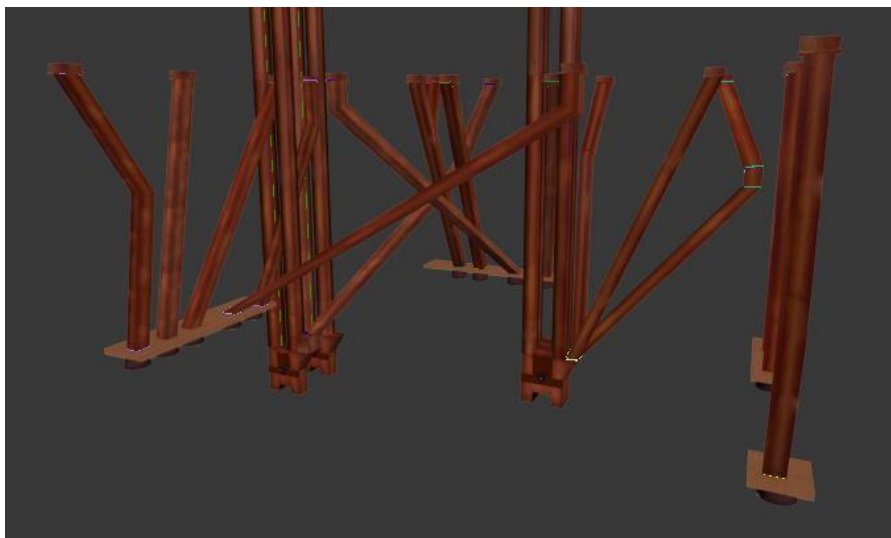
Vista del texturizado del ala norte de la planta baja.
